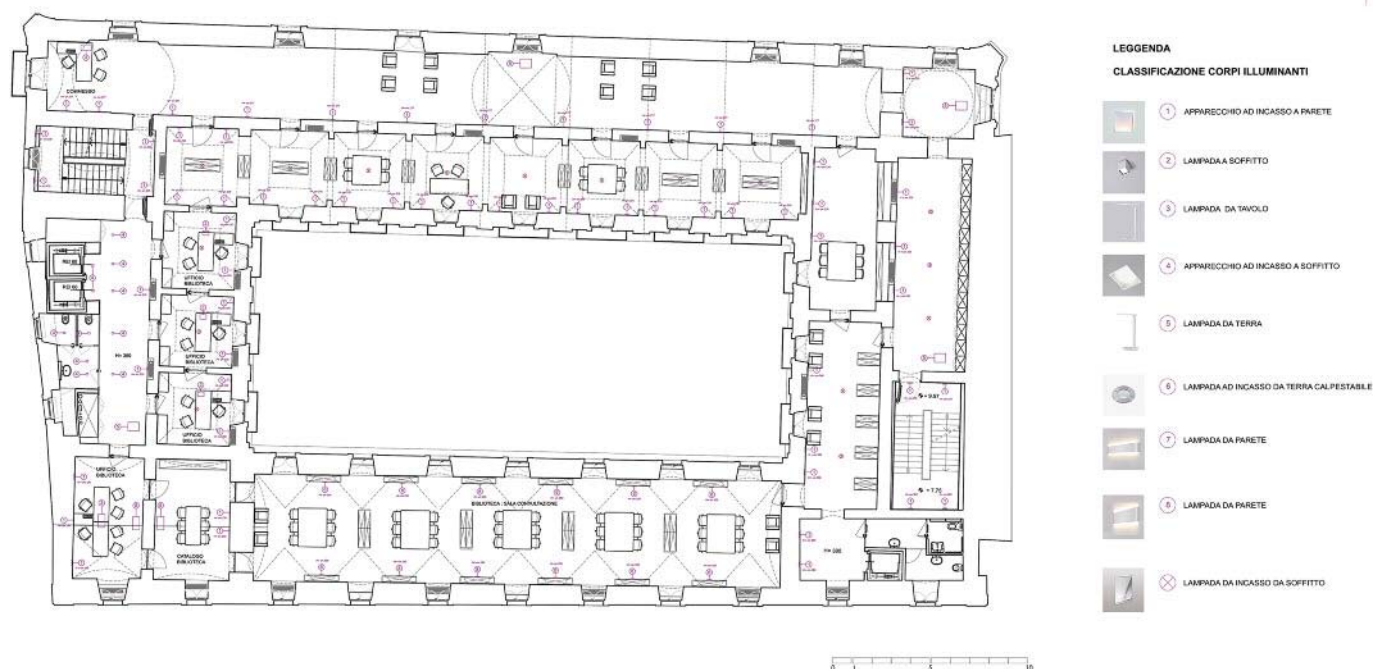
Pianta primo piano: arredo e apparecchi illuminanti.
